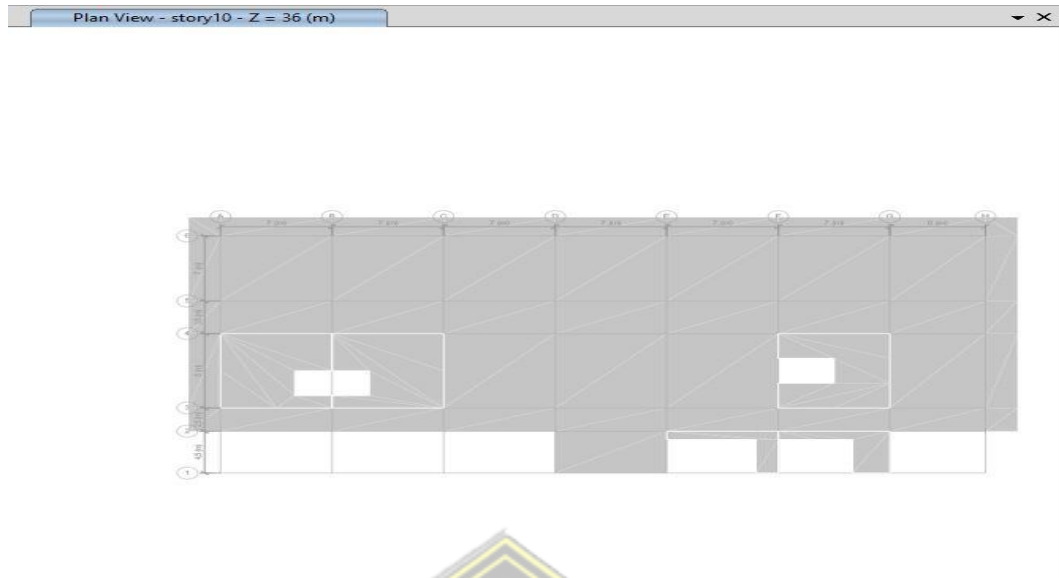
Denah Pelat Lantai 4 dan 5
